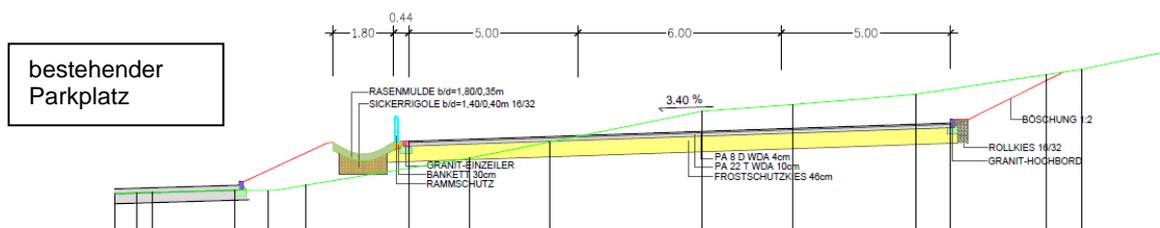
Schnitt Parkplatz Ost (N3, Auszug aus dem Lageplan IB BG Trauntal, technischer Ausführungsplan ohne Bepflanzung)
